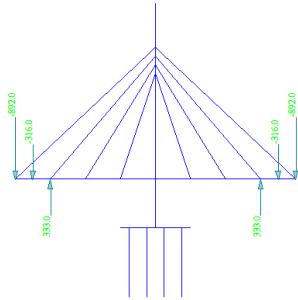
48 Permodelan saat Construction Stage8 (CS 8)
